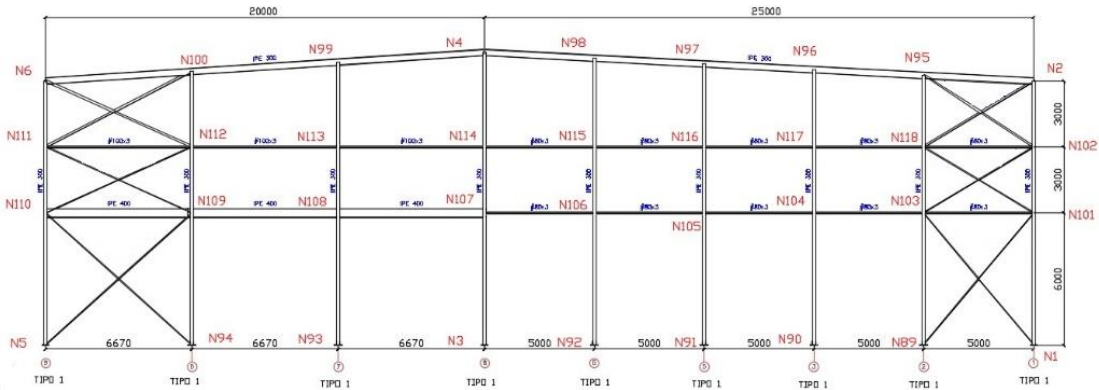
Pórtico fachada A. (Fuente: Creación propia)
